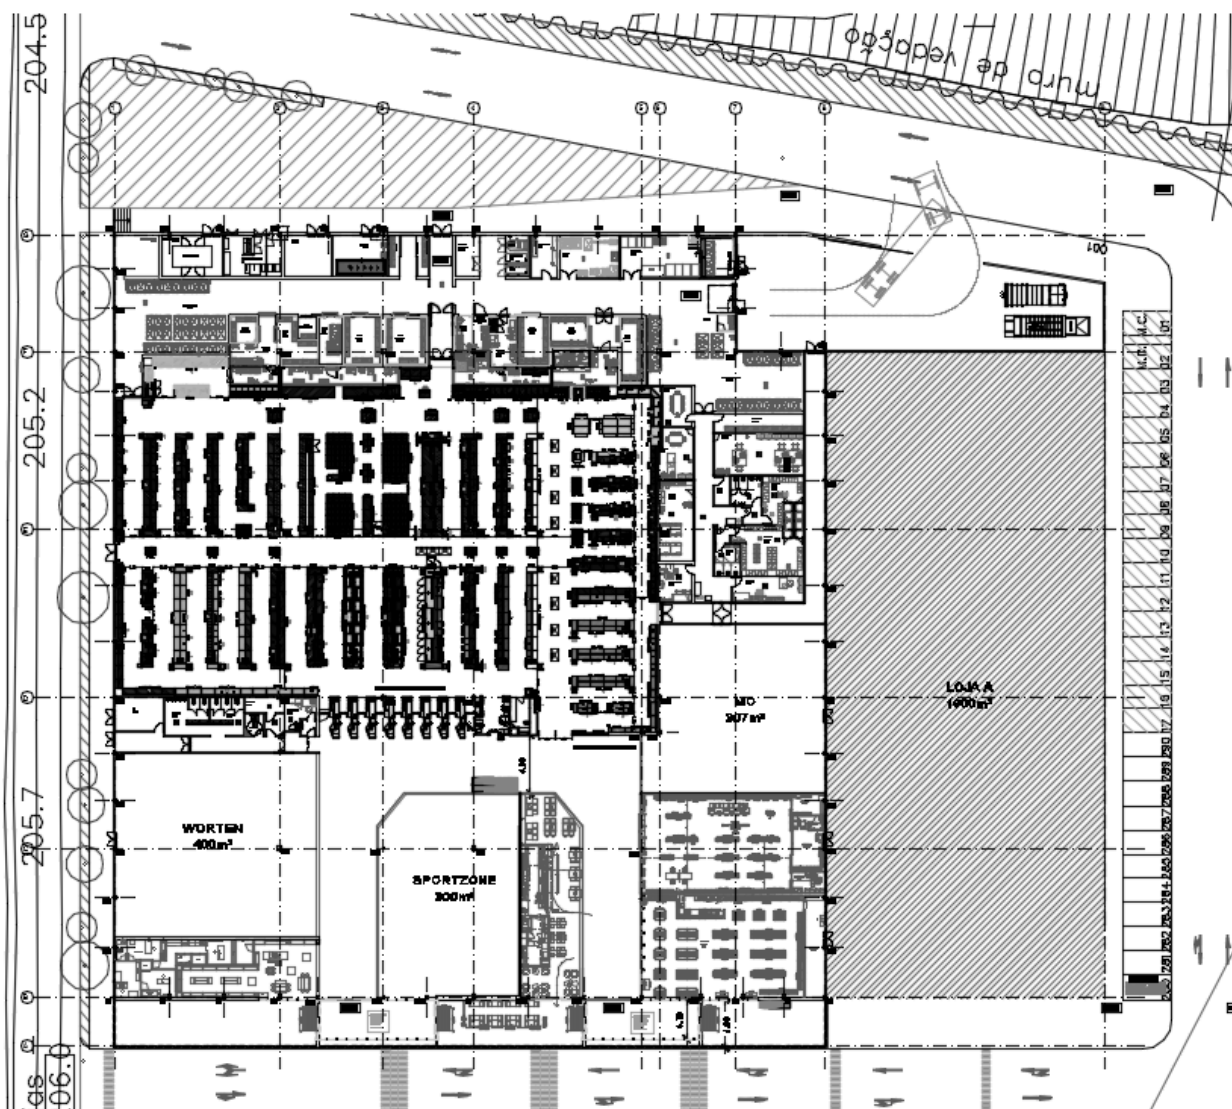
Planta de arquitetura do Continente de Beja.
